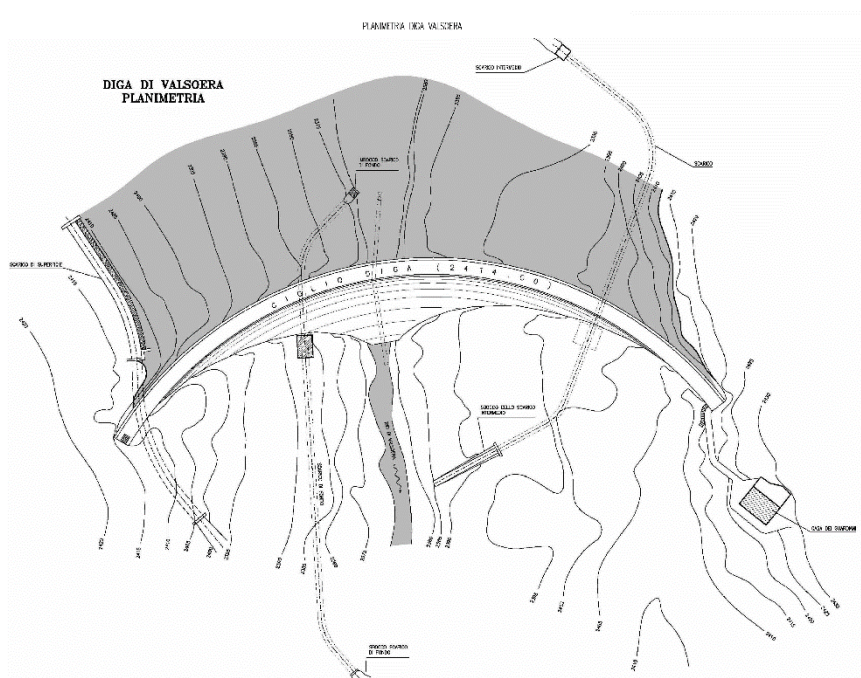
Lago di Valsoera – planimetria con indicazione della posizione del misuratore
